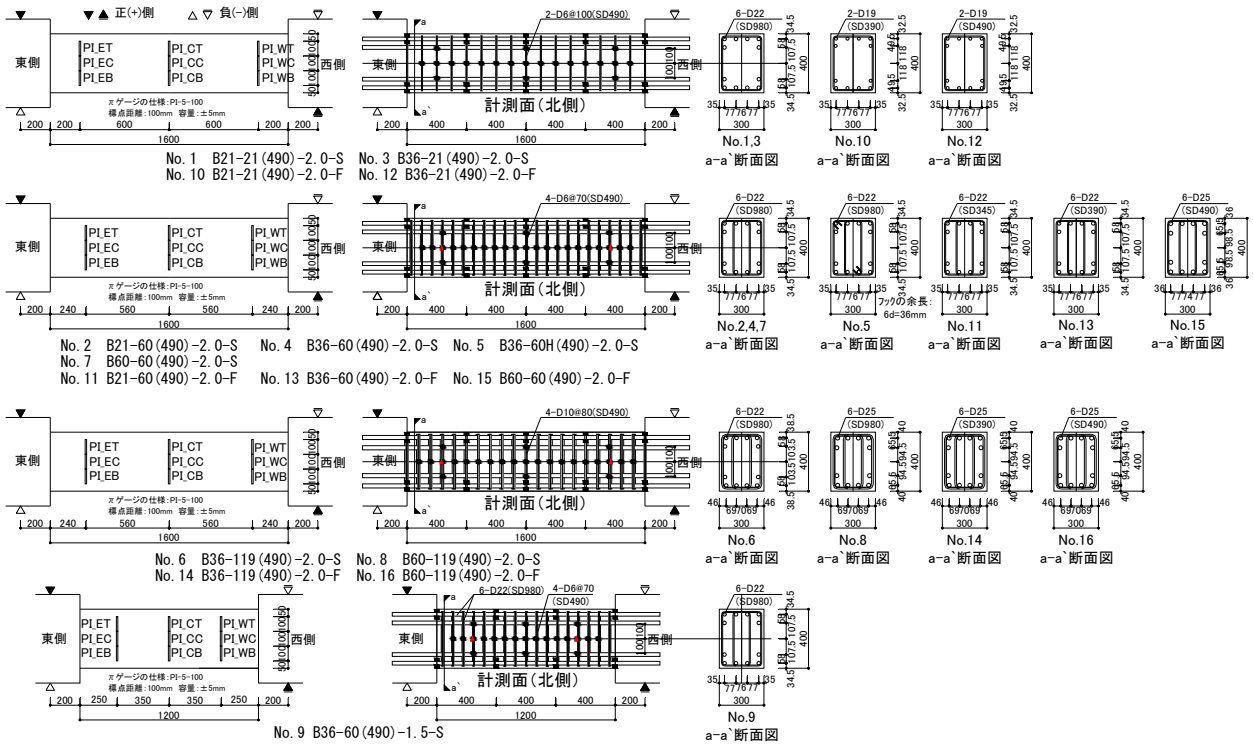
配筋図およびπゲージ、ひずみゲージ位置図
